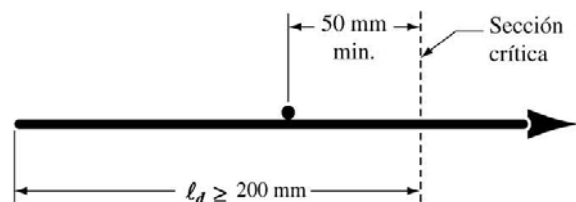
Desarrollo de refuerzo electrosoldado de alambre corrugado
